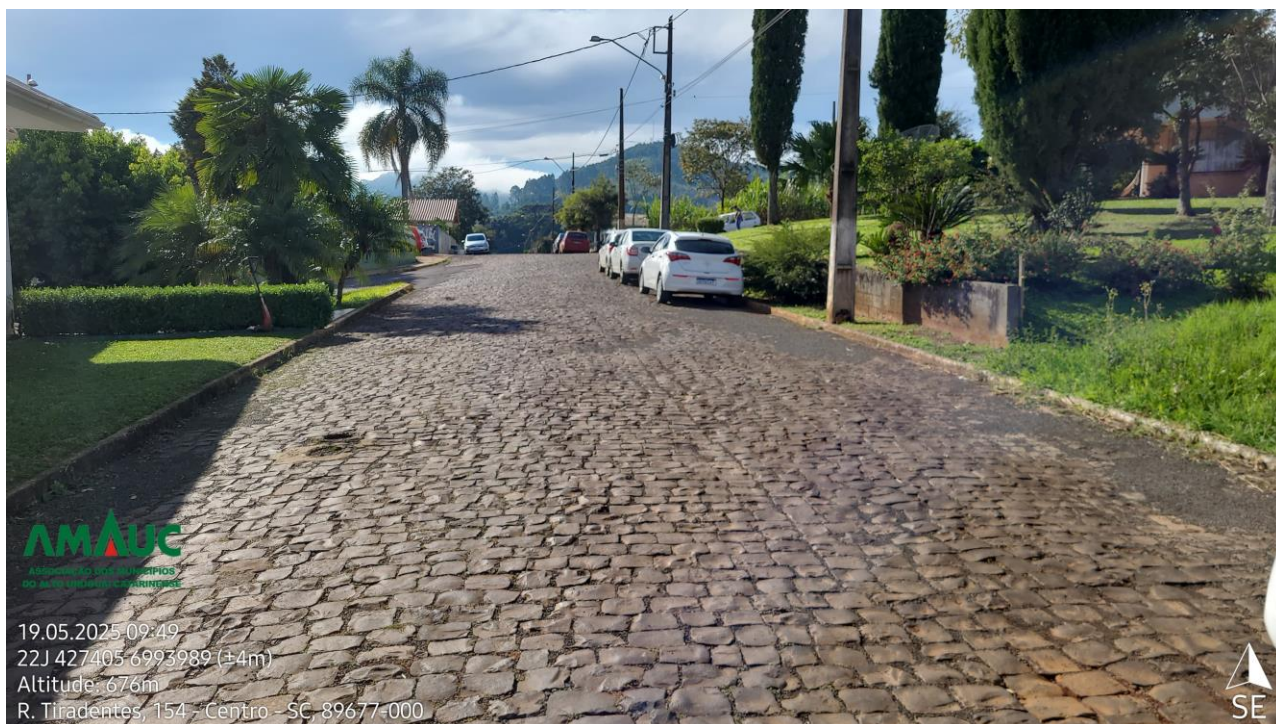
Fotos do local (área com recapeamento e pavimento)
